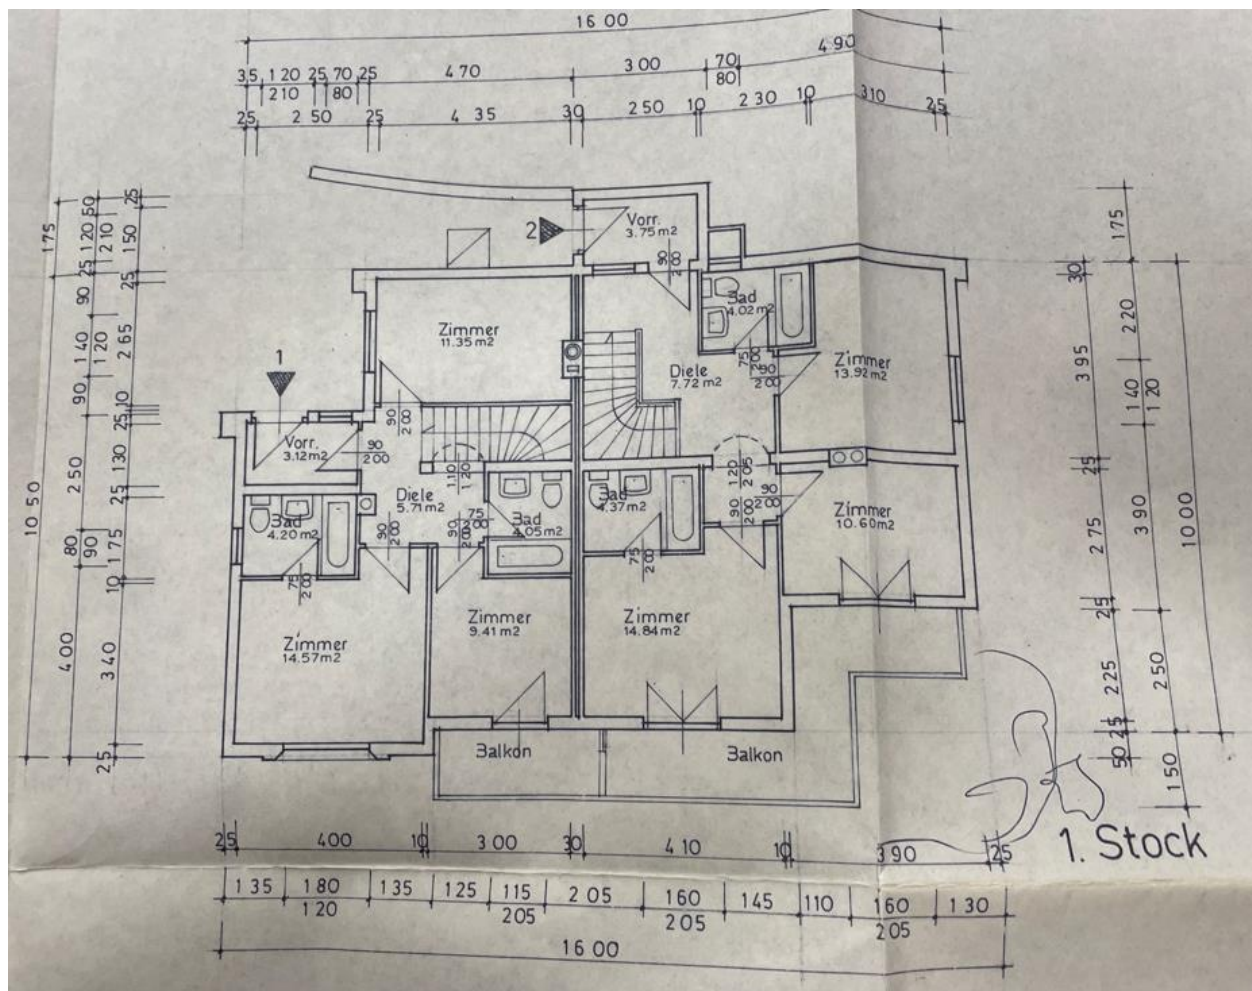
Grundriss 1.Obergeschoss
